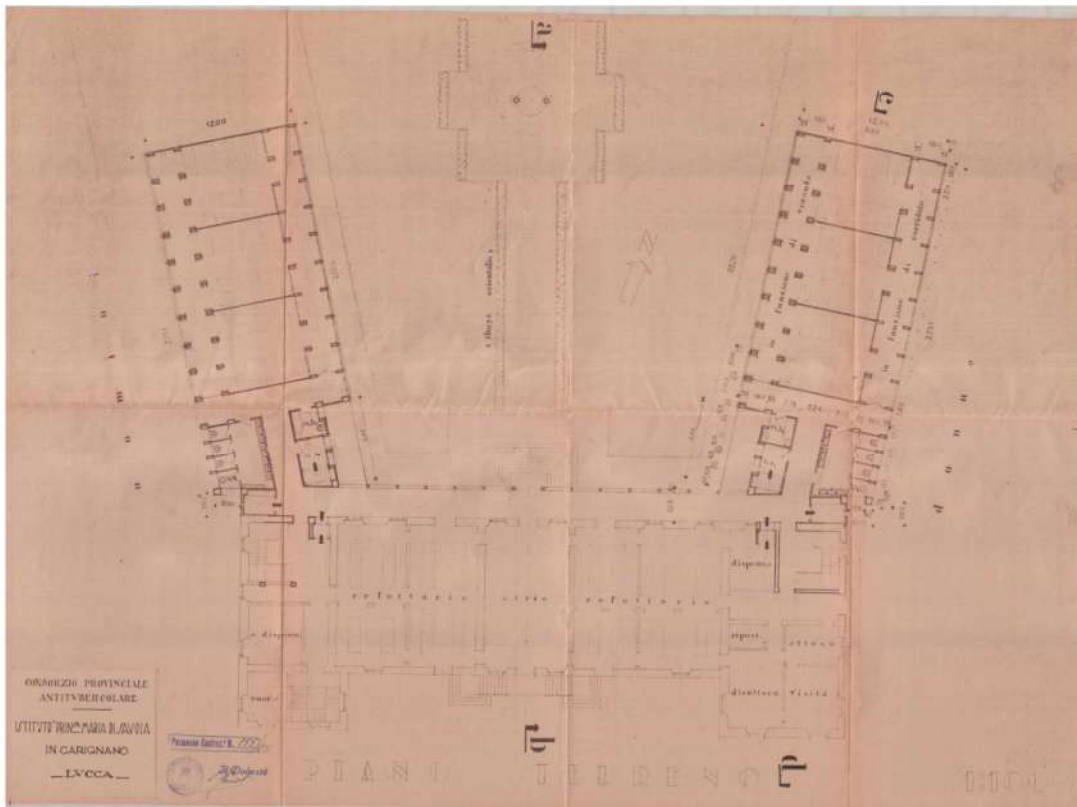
pianta piano terreno con l'ampliamento delle ali in c.a..
